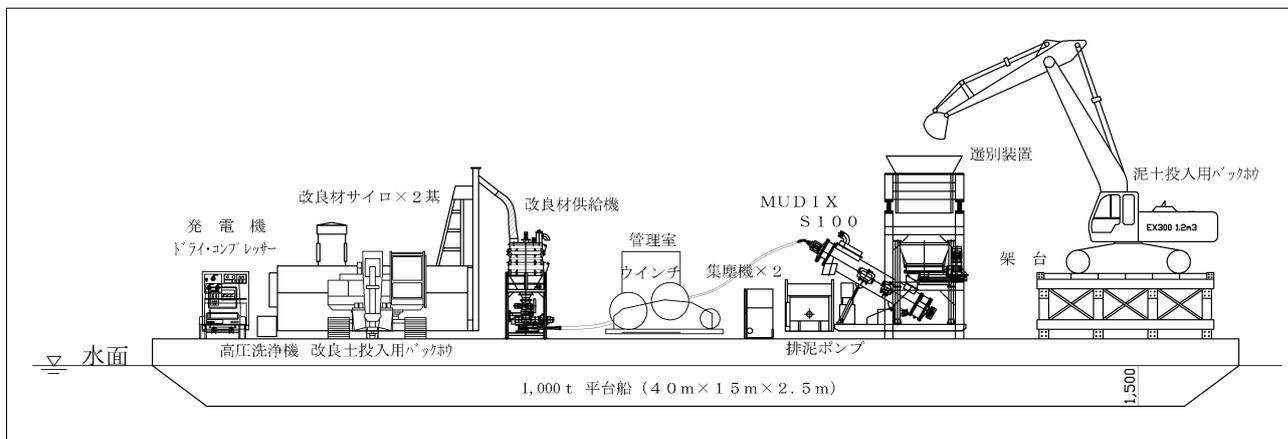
台船施工時 主要機械配置図 (MUDIX-S-100)
